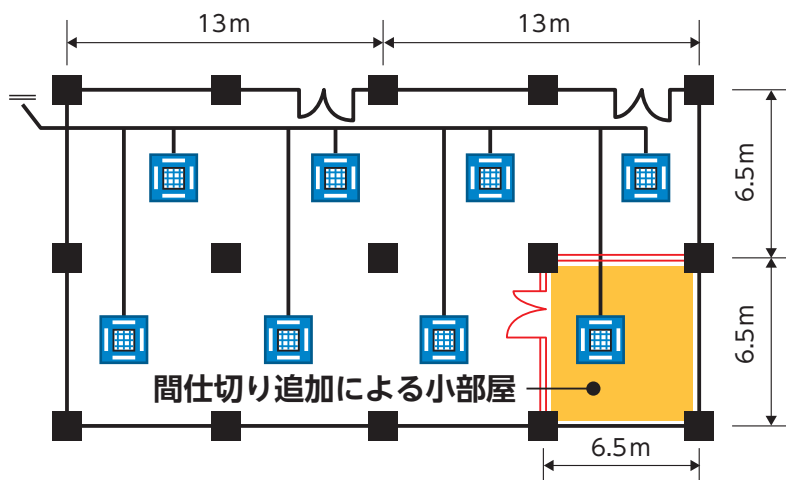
設計例（間仕切り変更） 間仕切り追加後の平面図
